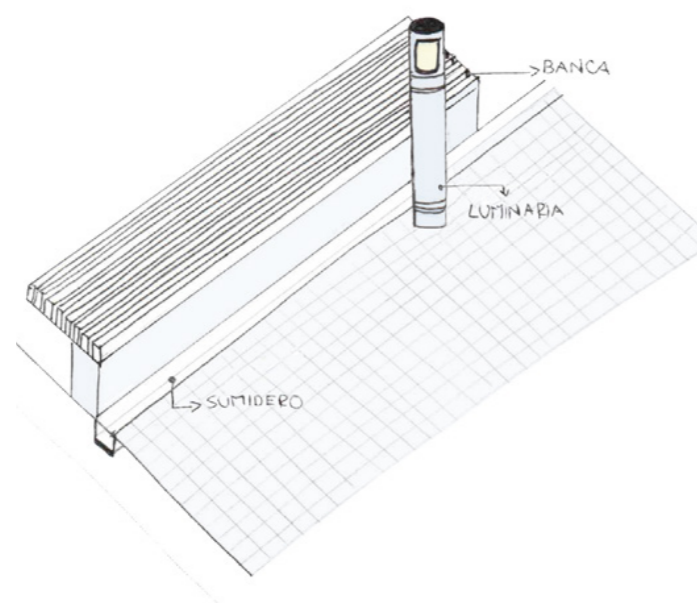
Banca + Pavimento + Luminaria . Fuente propia
